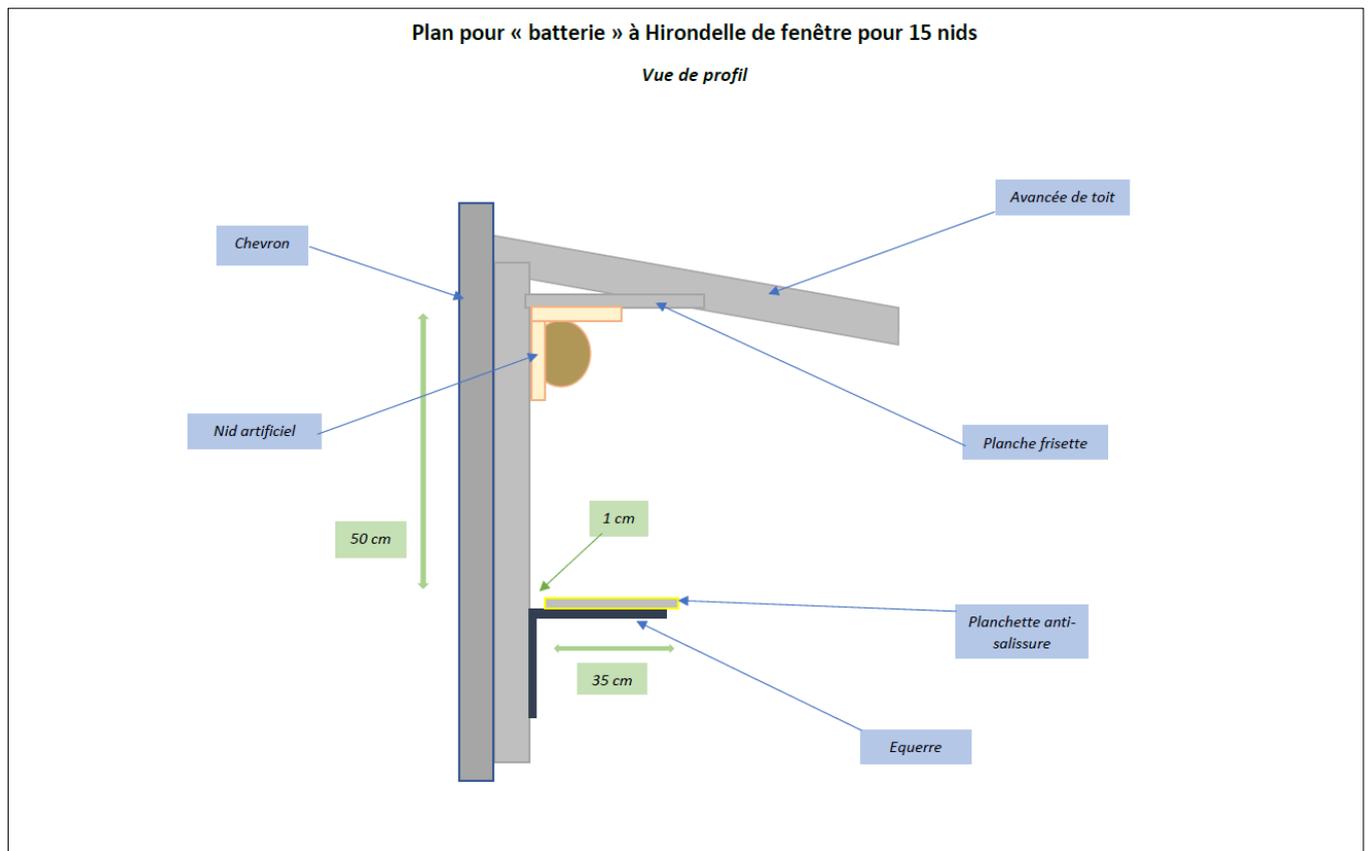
plan pour batterie à Hironnelle de fenêtre vue de profil
